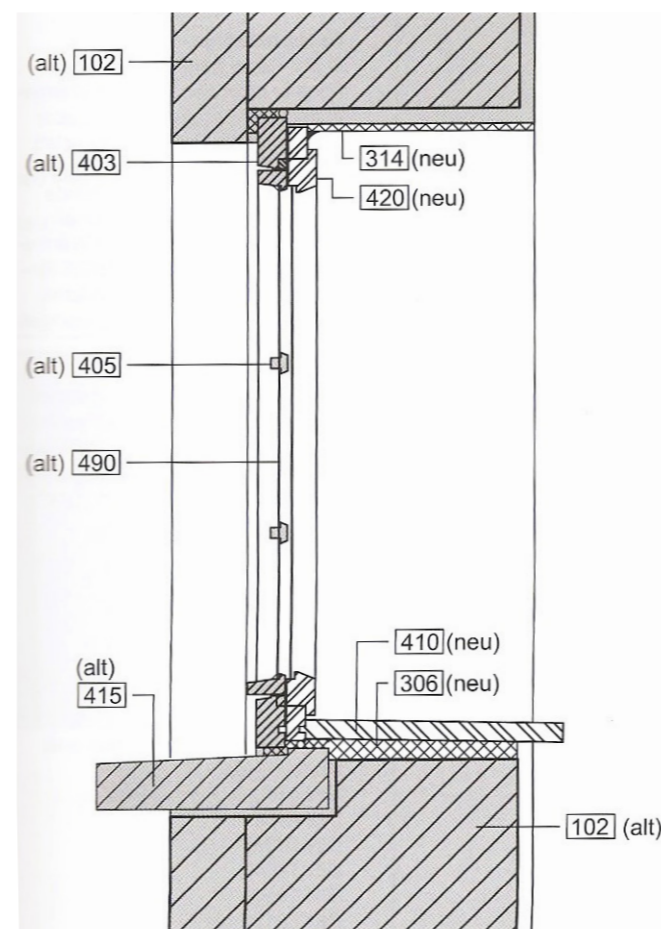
Detail Aufdoppelung eines Einfachfensters zum Verbundfenster M 1:10
